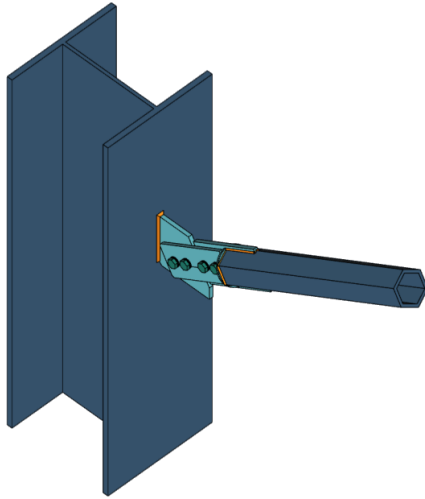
Articulation poteau-barre de contreventement en tube rond avec éclissage sur gousset
